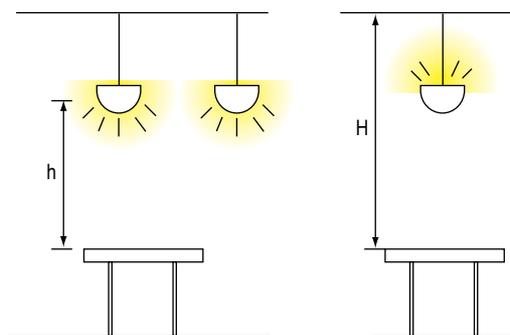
Illuminazione diretta (a) e indiretta (b).
